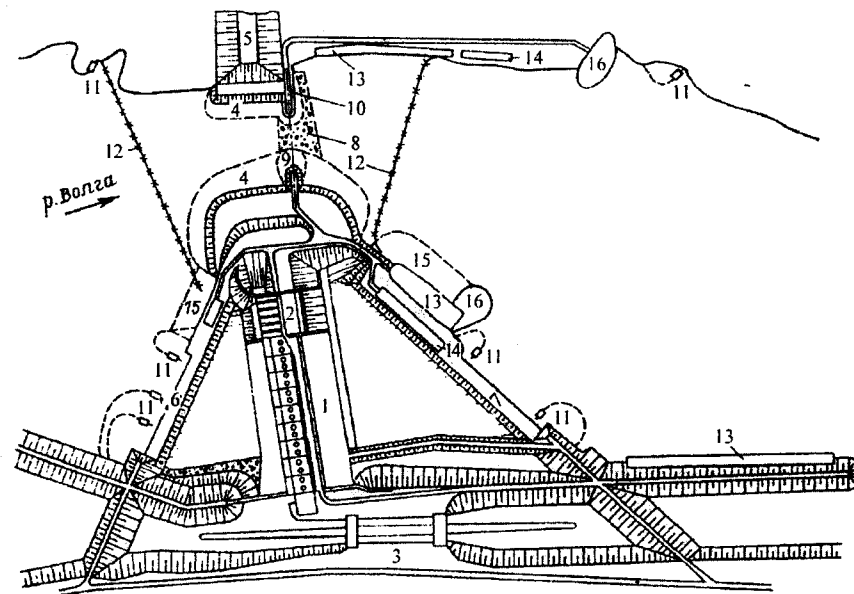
Схема перекрытия р. Волги пионерным способом на Чебоксарской ГЭС:
